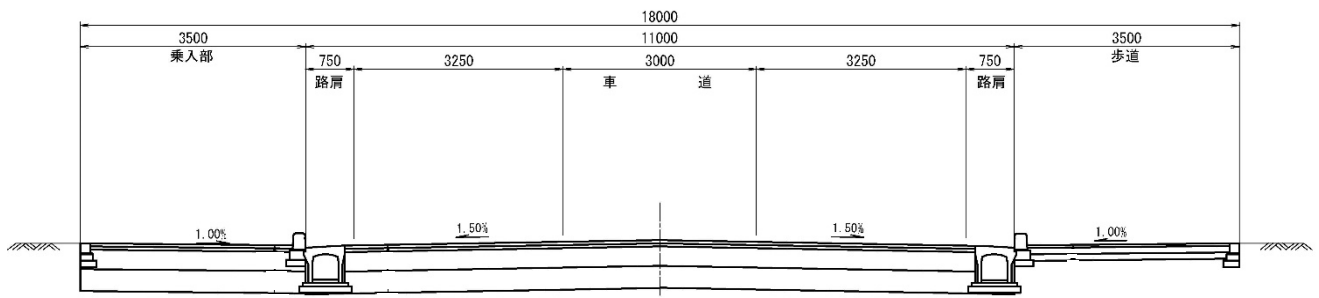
(1) 標準断面図 (主要地方道行田・蓮田線バイパス 幅員 18m)
